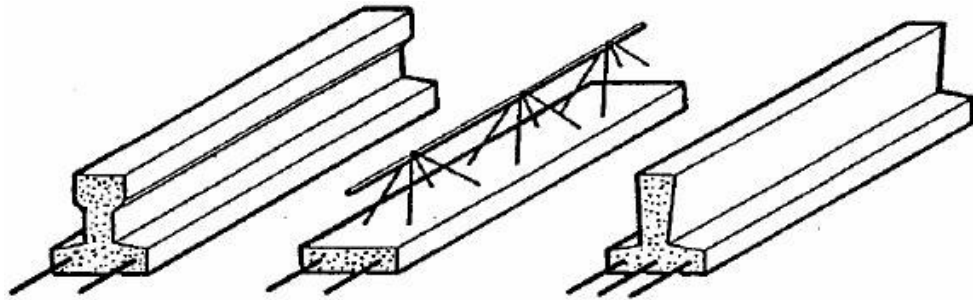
Vigotas de concreto pré-moldado: armada, treliçada e protendida
